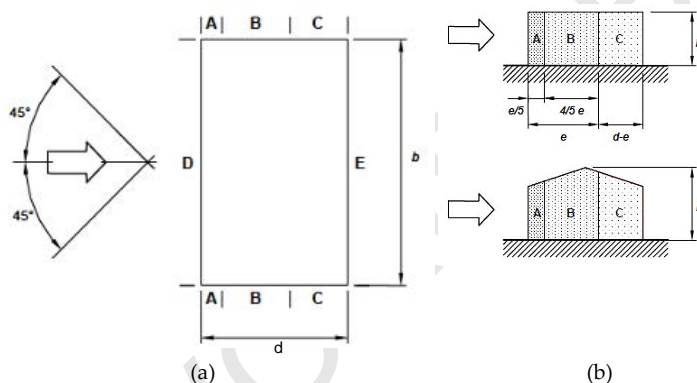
a) Schema planimetrico di riferimento, b) Suddivisione delle pareti verticali di edificio a pianta rettangolare in zone di uguale pressione (prospetti laterali)
